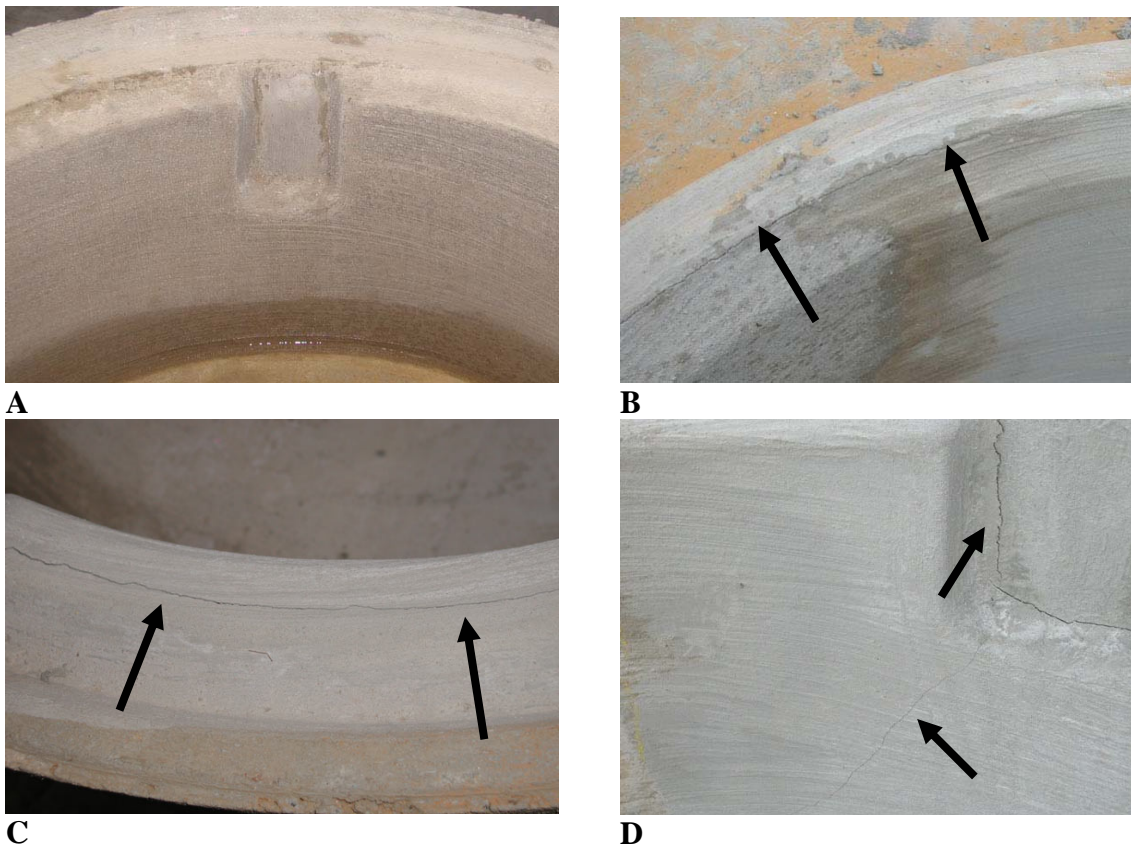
Optische Inspektion der beschichteten Schachtelemente 28 Tage nach der Beschichtung. A: Optisch keine Mängel erkennbar (Schachtelement M5). B: Spaltbildung zwischen Mörtelbeschichtung und Betonwandung (Schachtelement M1). C: Spaltbildung zwischen Mörtelbeschichtung und Betonwandung (Schachtelement M2). D: Risse in der Mörtelbeschichtung (Schachtelement M1).
